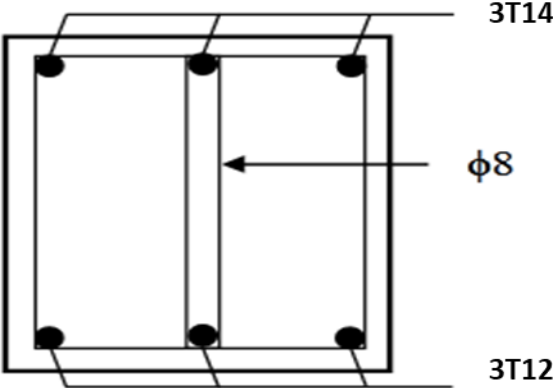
schéma de ferrailage de poutre palière (30x35)
